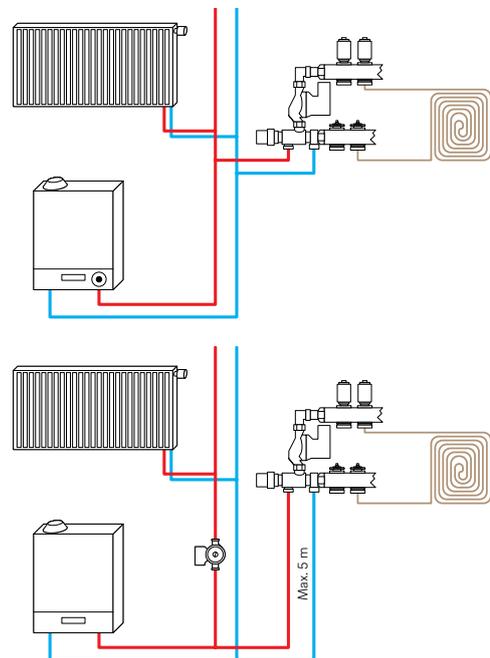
Anschlusschema mit primärer Umwälzpumpe im Wärmeerzeuger (oben) / mit externer primärer Umwälzpumpe (unten)
